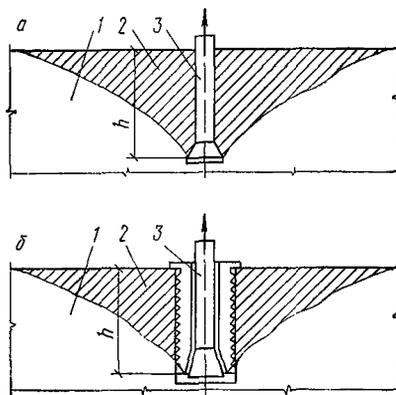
Схема испытания бетона на отрыв со скалыванием
